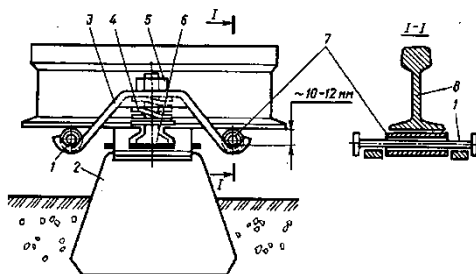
Подвесные ролики для разрядки напряжений в плетях без перерыва движения поездов: 1 - ось ролика; 2 - железобетонная шпала; 3 - коромысло; 4 - дополнительная двухвитковая шайба; 5 - гайка; 6 - клеммный болт; 7 - трубка ролика; 8 - рельс
